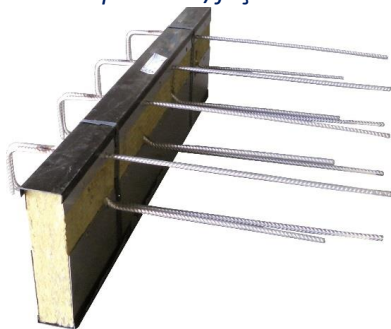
Modèle VIP - Liaison plancher avec prédalles/façade
